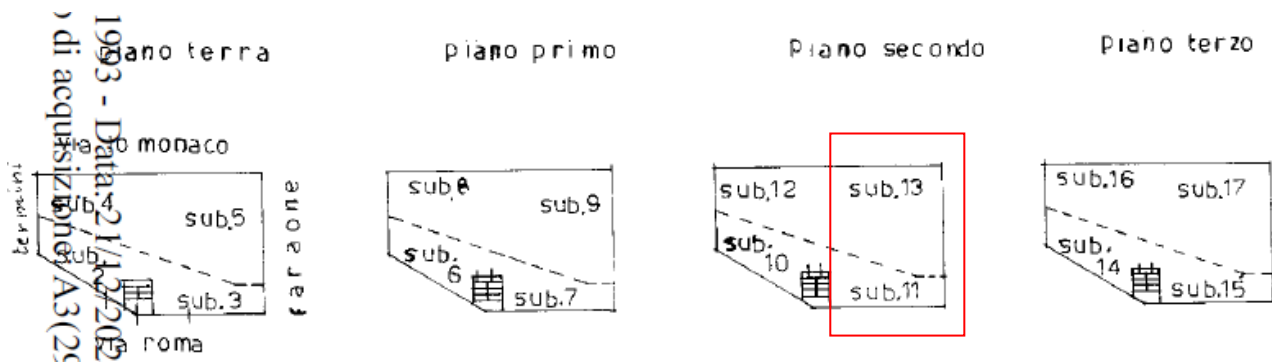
Elaborato planimetrico del 20.06.1986 con individuazione dell'unità immobiliare (sub. 11 forma u.i.u. con il sub. 13).
